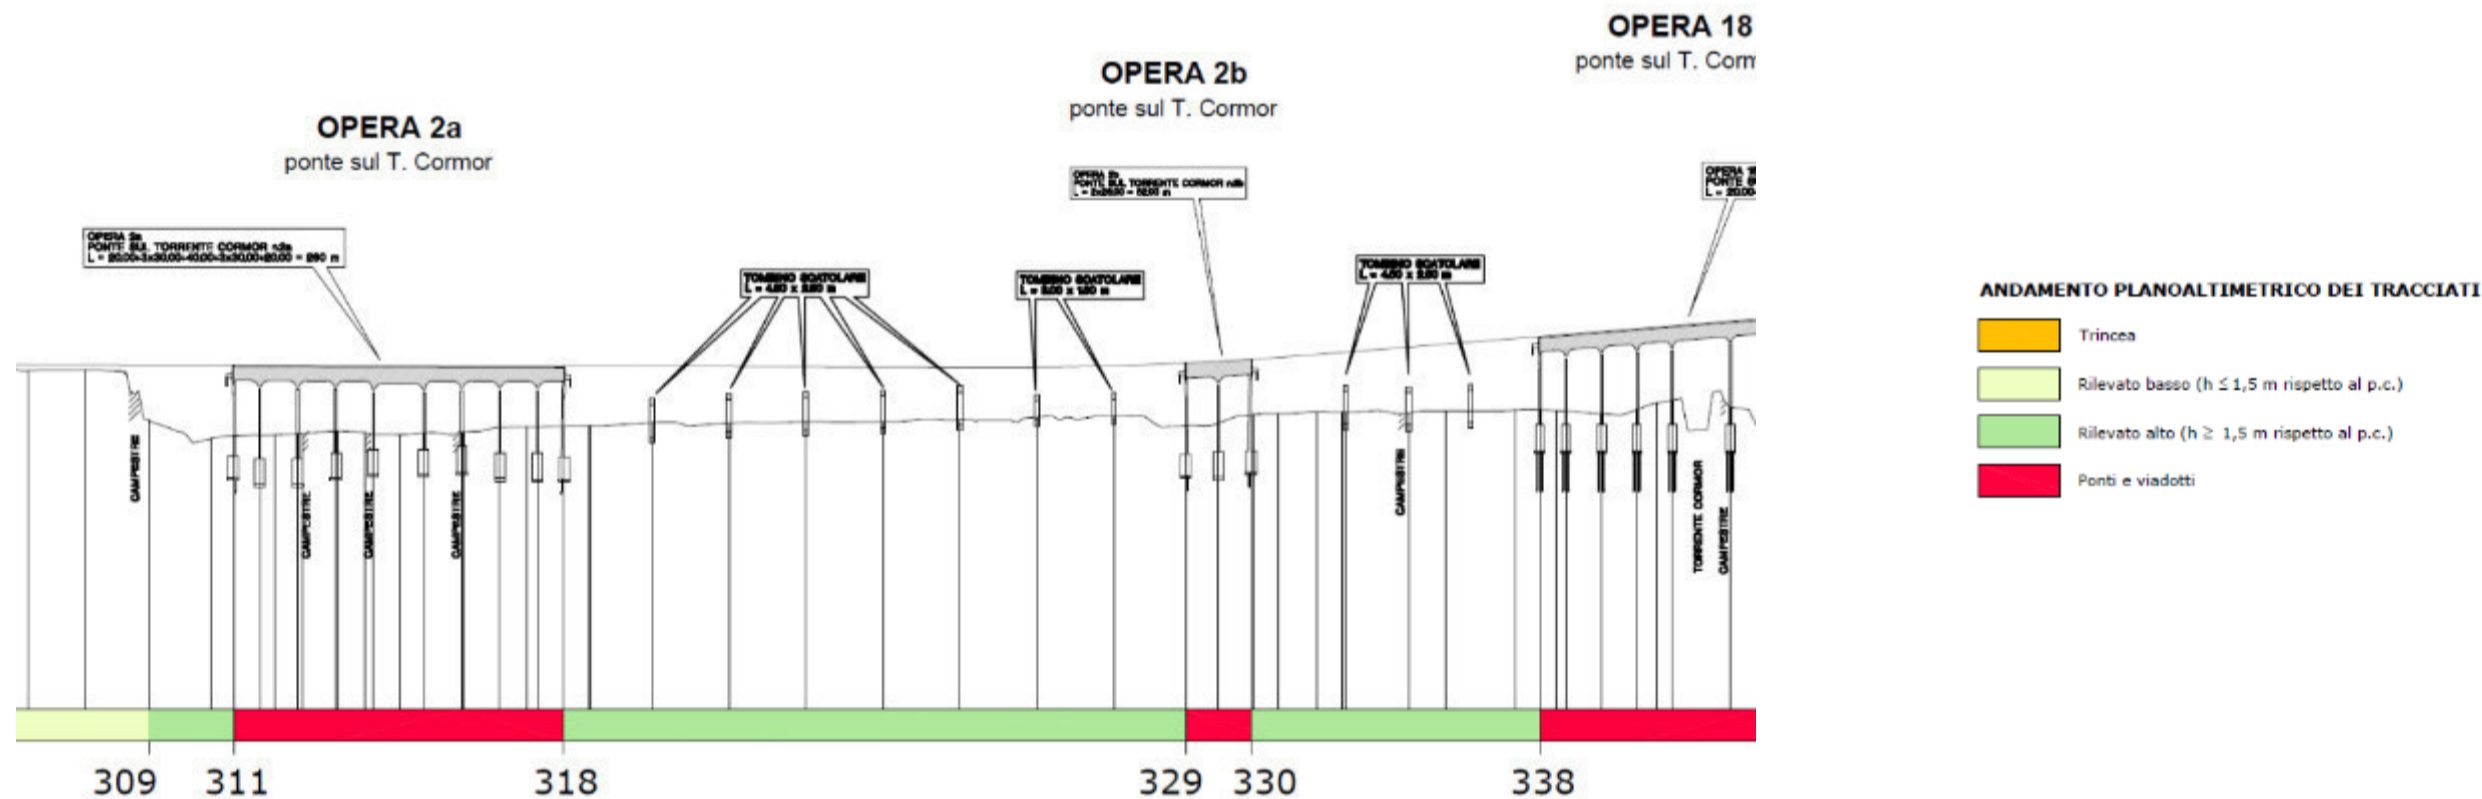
Profilo di progetto presso l'opera 2a da cui emerge la permeabilità generata dalle opere d'arte maggiori e dai tombotti
